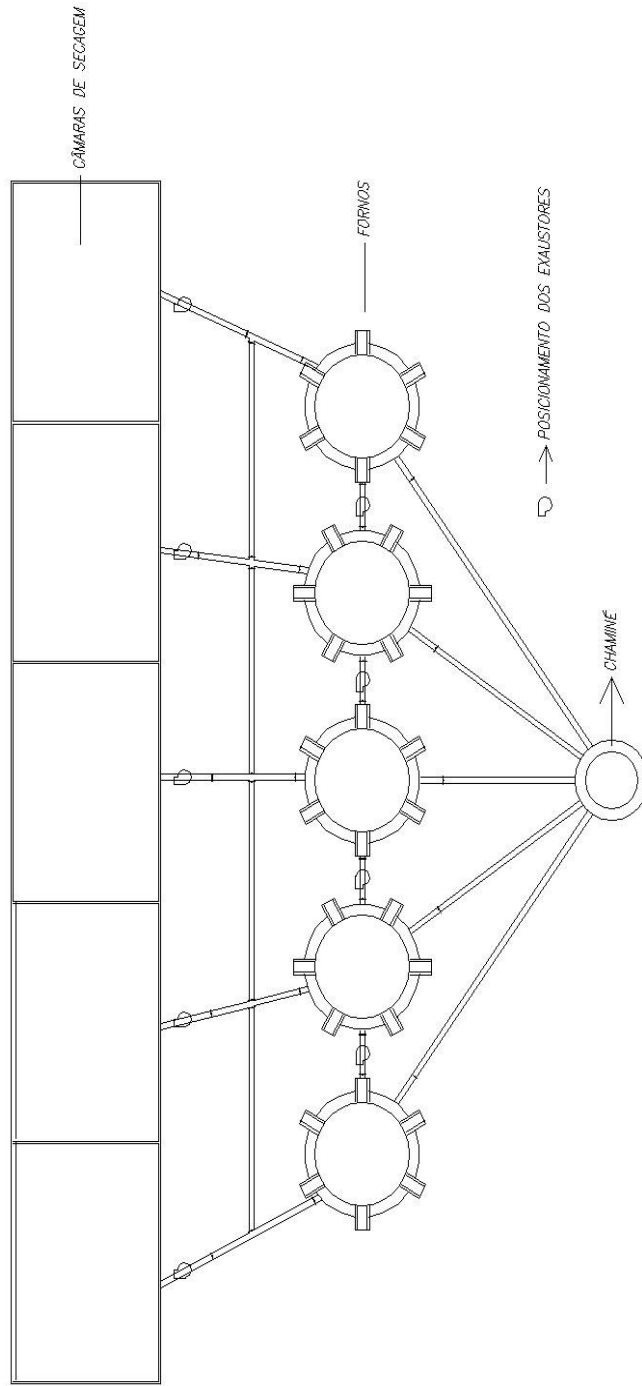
Planta baixa de interligação dos dutos que serão construídos.
